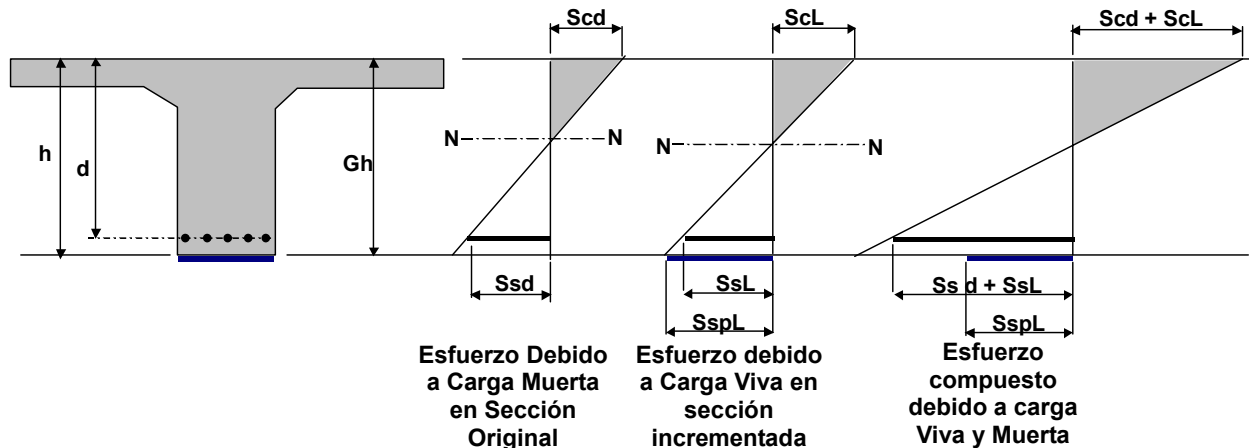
Esfuerzo de la Viga de Concreto reforzada al Adherir Placa de Acero
